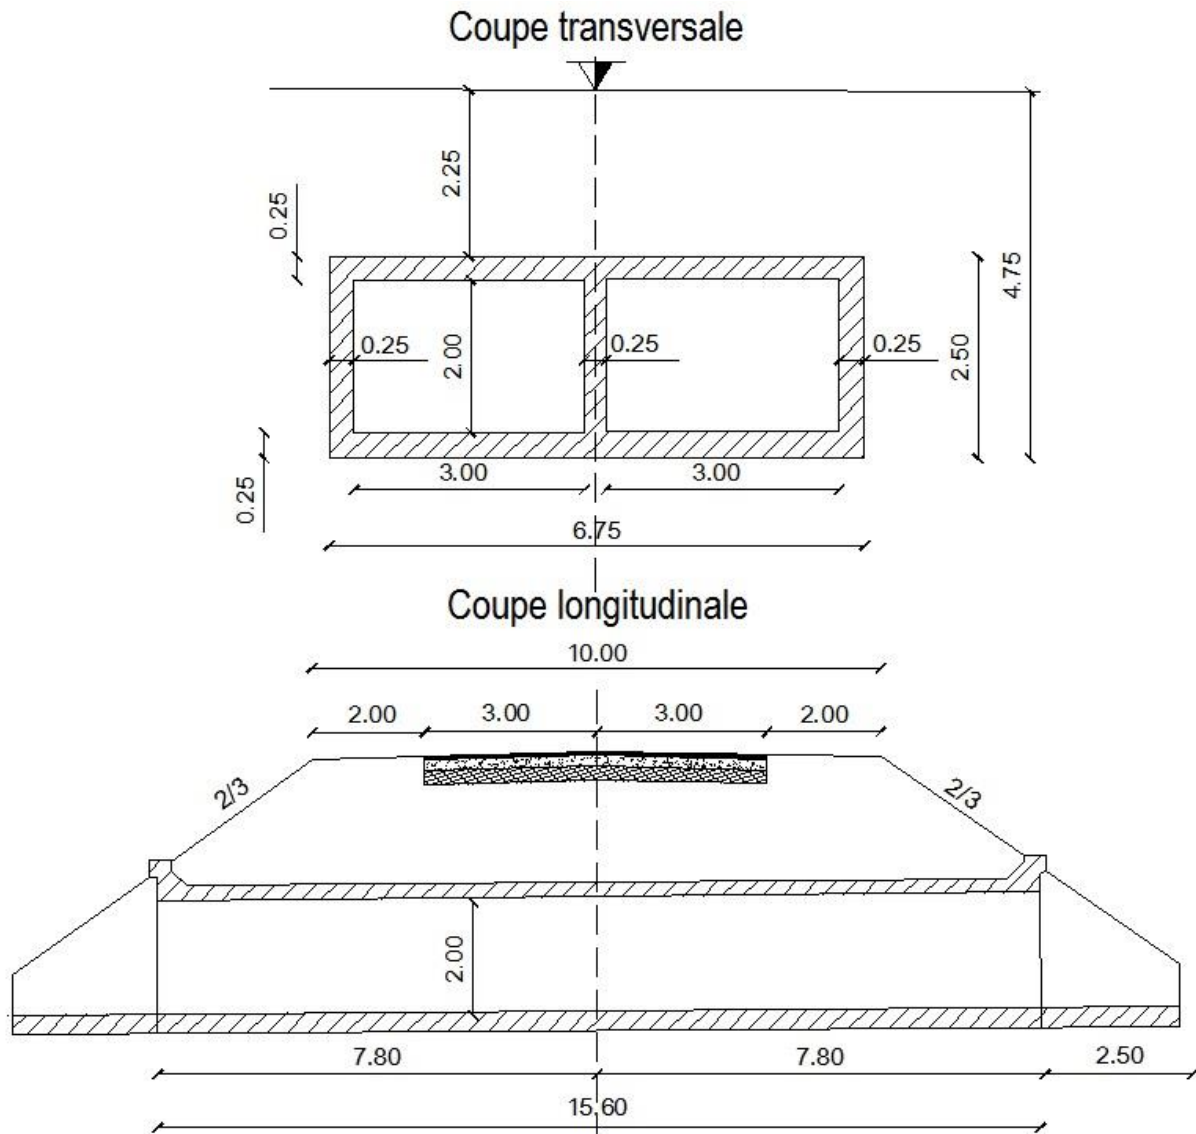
Coupe transversale et longitudinale du dalot étudié.
